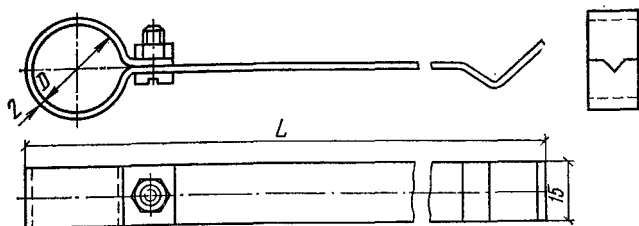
Держатели для крепления кронштейнов умывальников на кирпичных и бетонных стенах дюбель-гвоздями
